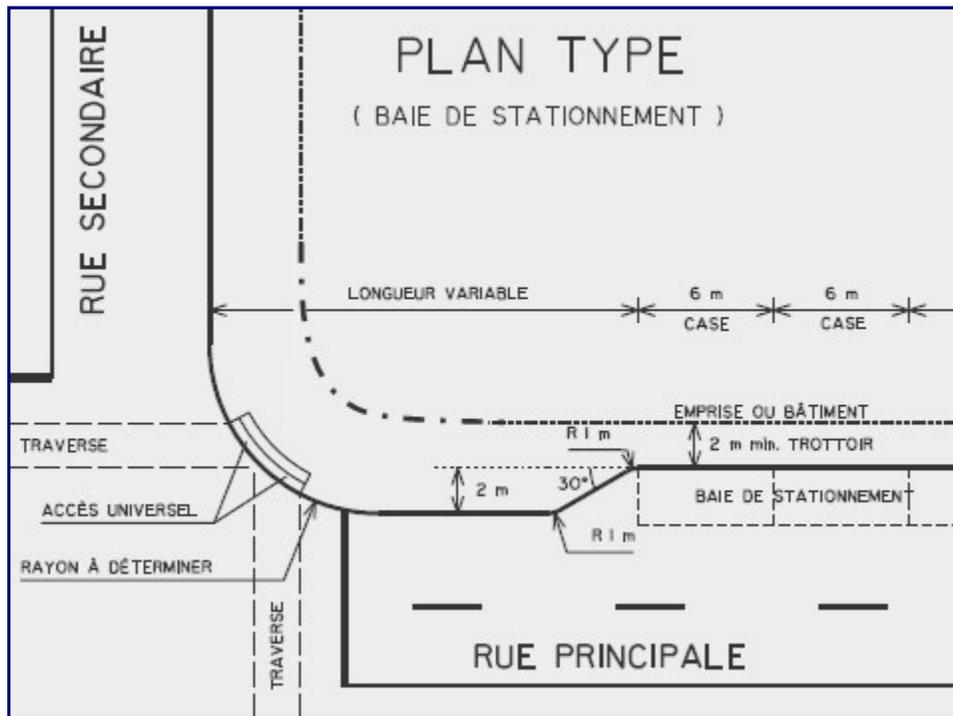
PLAN TYPE POUR BAIE DE STATIONNEMENT
